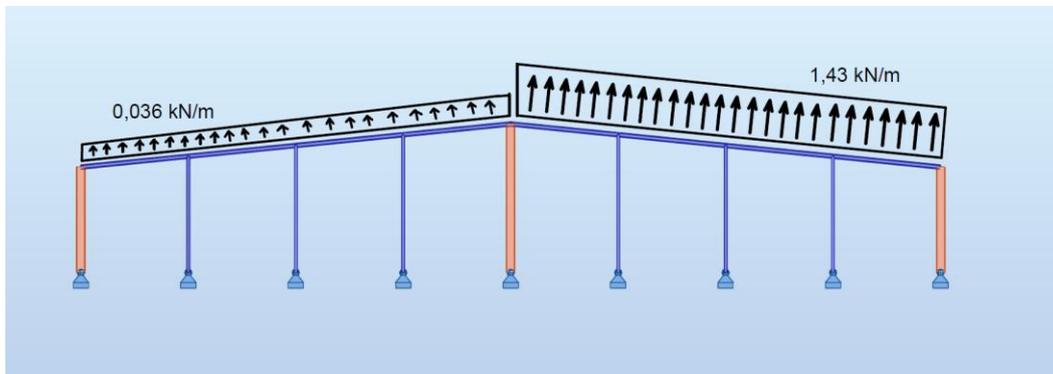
REPRESENTACIÓN TIPO 2 DEL PÓRTICO DE FACHADA CON CARGA DE VIENTO EN DIRECCIÓN TRANSVERSAL A LA CUBIERTA
